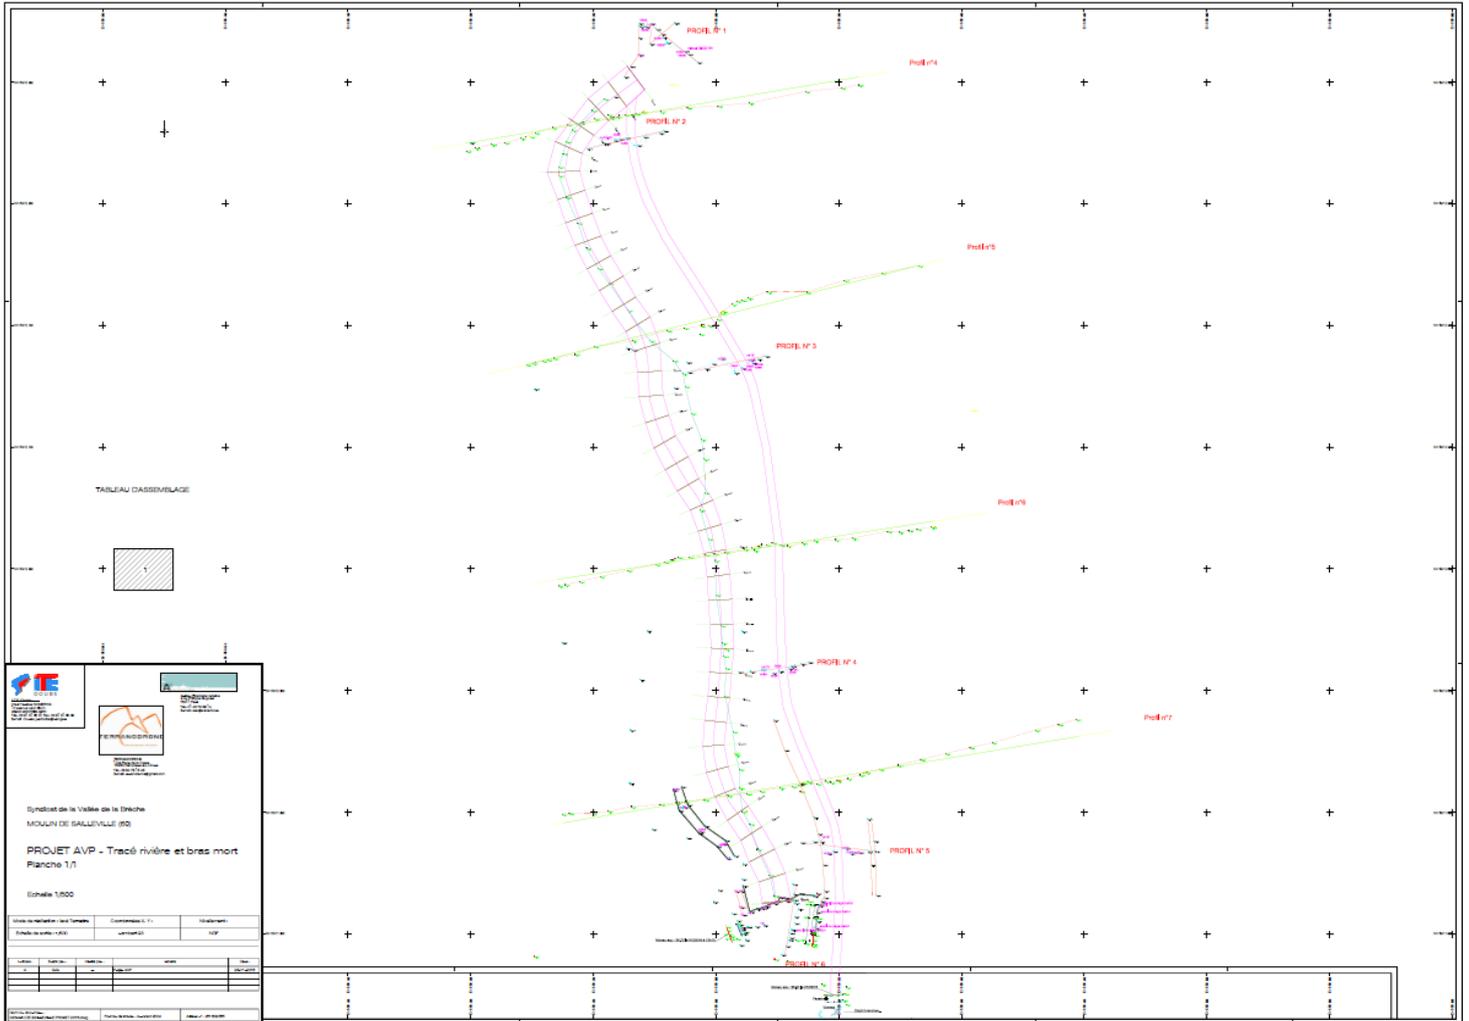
extrait du plan projet (Format DWG – Autocad)
